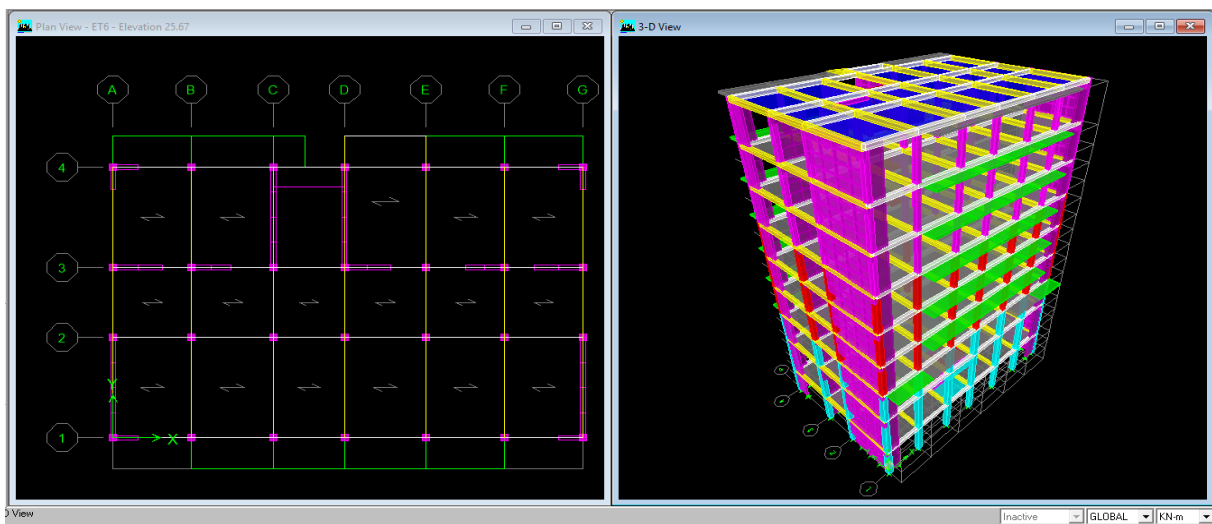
Vue en plan des éléments structuraux d'un étage
